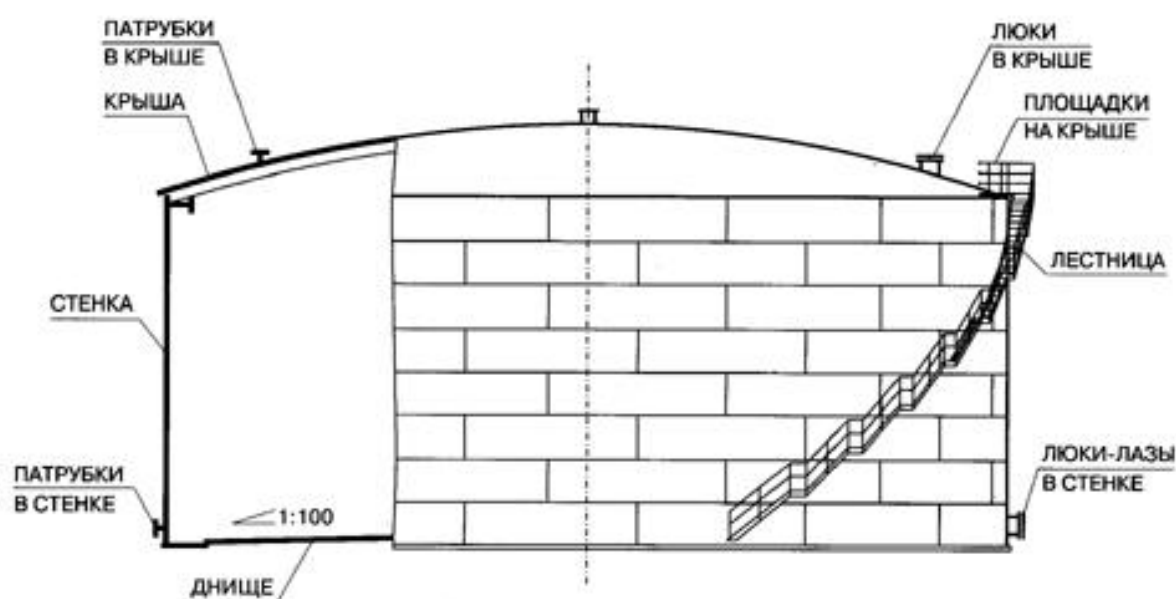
Основные элементы конструкции нефтяного резервуара типа РВС [36]
